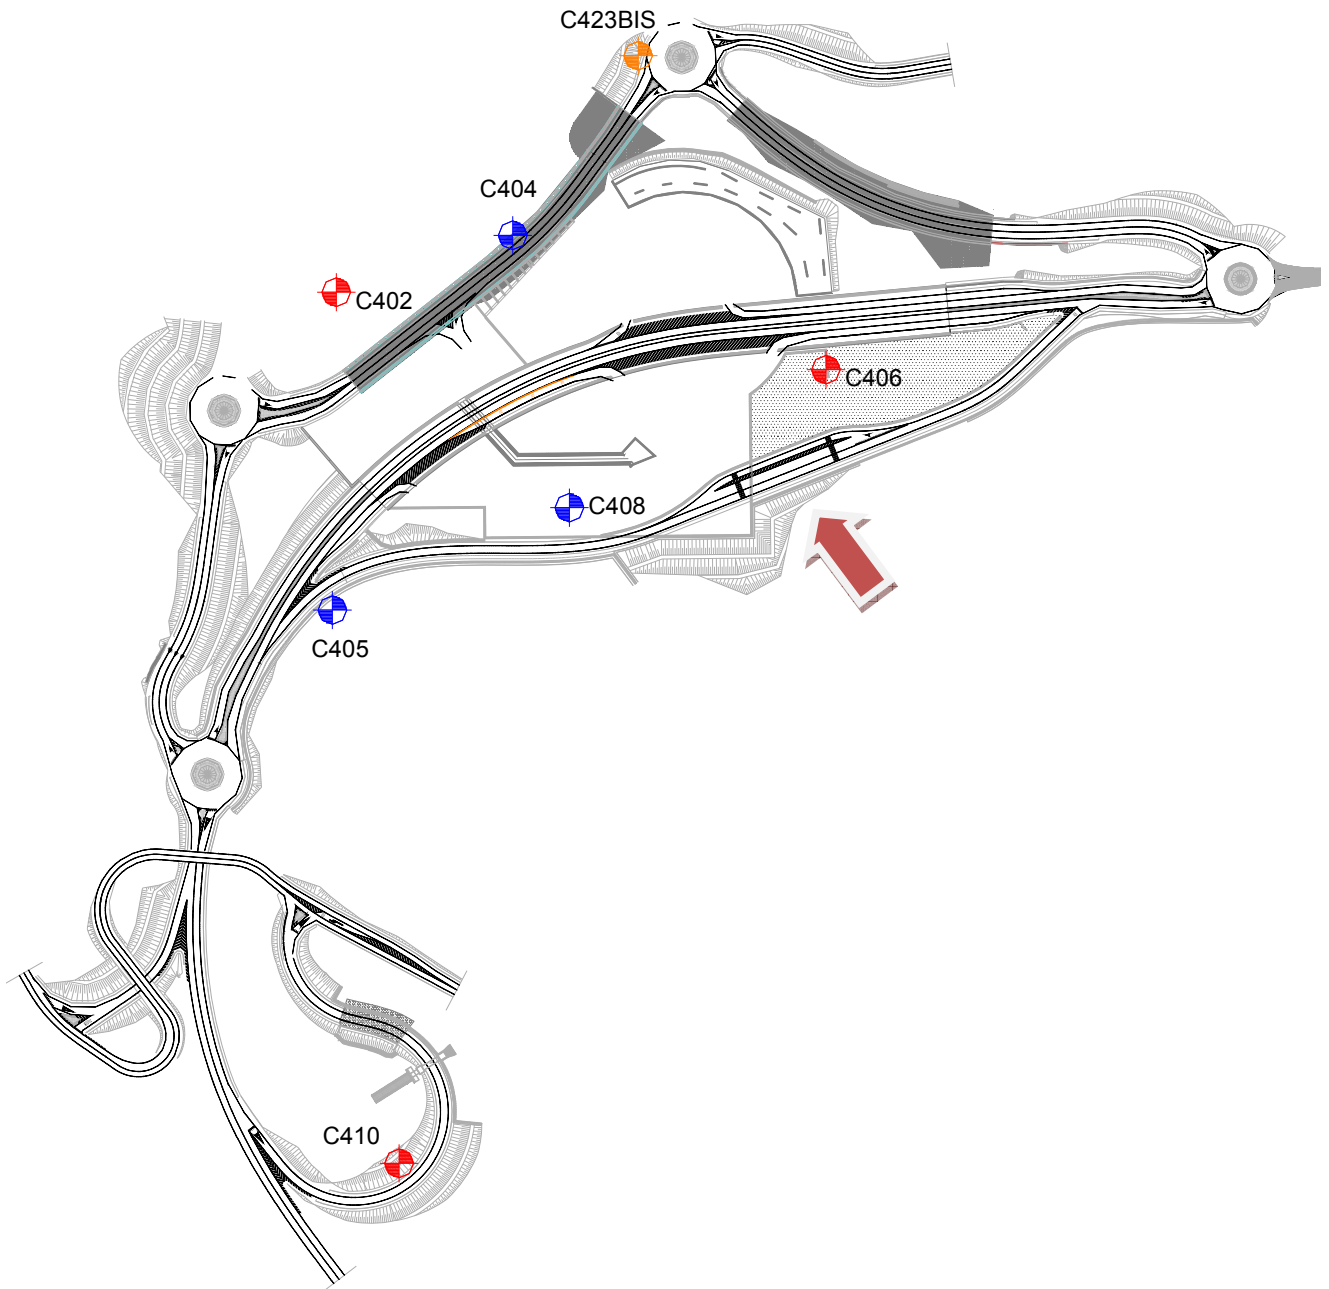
Stralcio planimetrico con ubicazione delle opere e dei sondaggi
